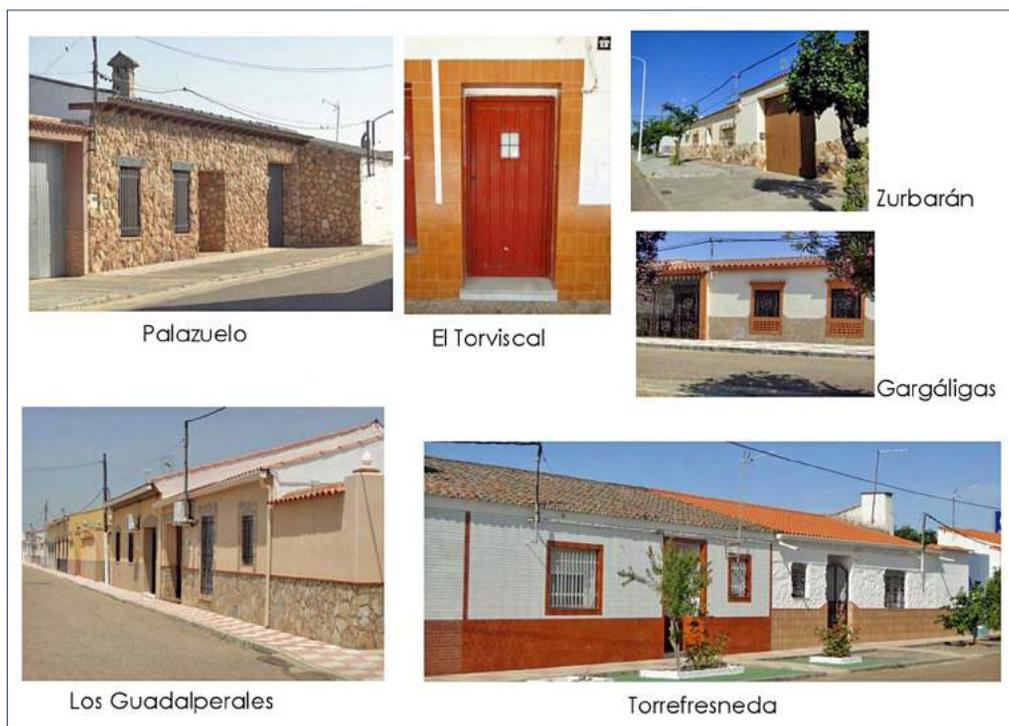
Colocación de revestimientos modernos en las fachadas de las viviendas. Un proceso que hace perder la unidad estética y constructiva.
